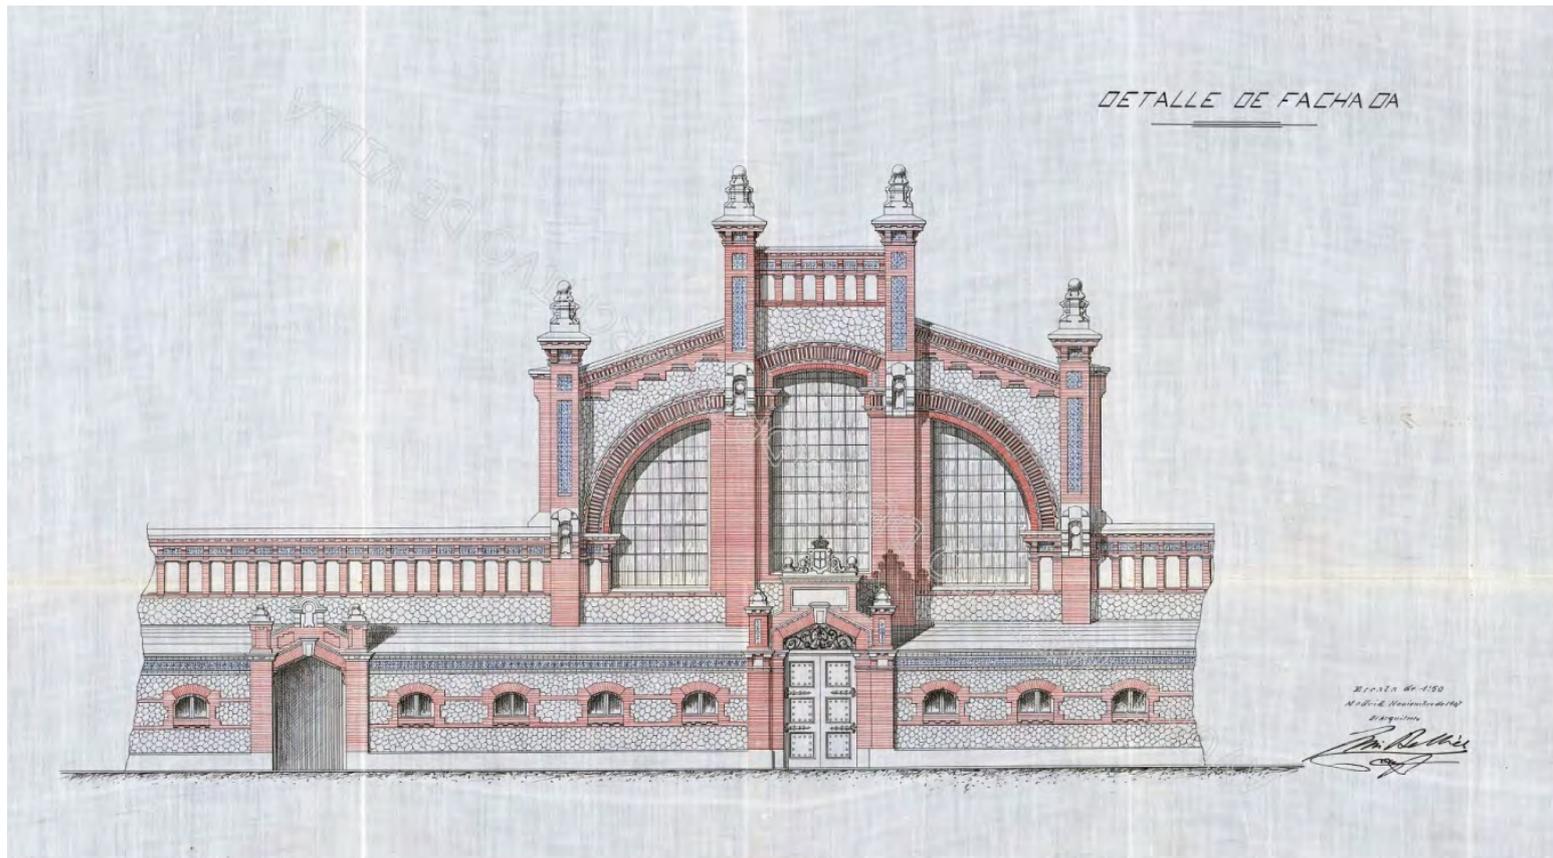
Detalhe da Fachada, imagem do Arquivo de la Villa, Madrid.
